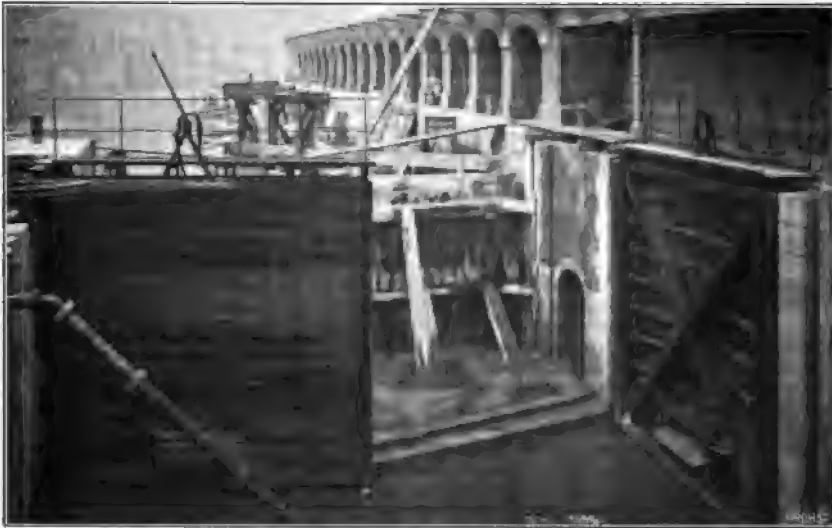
Schleusenbau am Mühlendamms zu Berlin.
